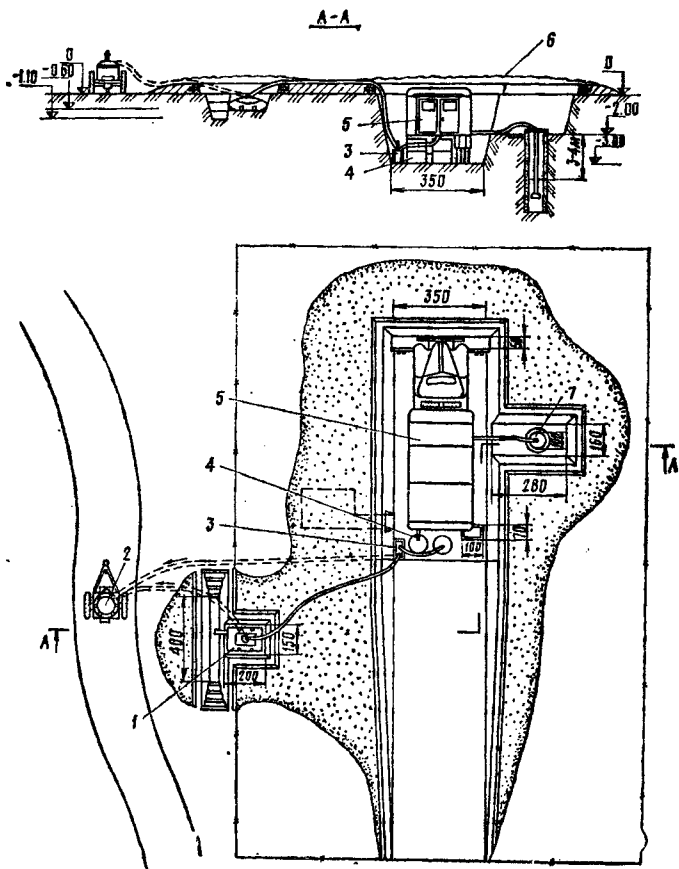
Пункт водоснабжения на передвижной опреснительной установке ПОУ-4 (вариант):
